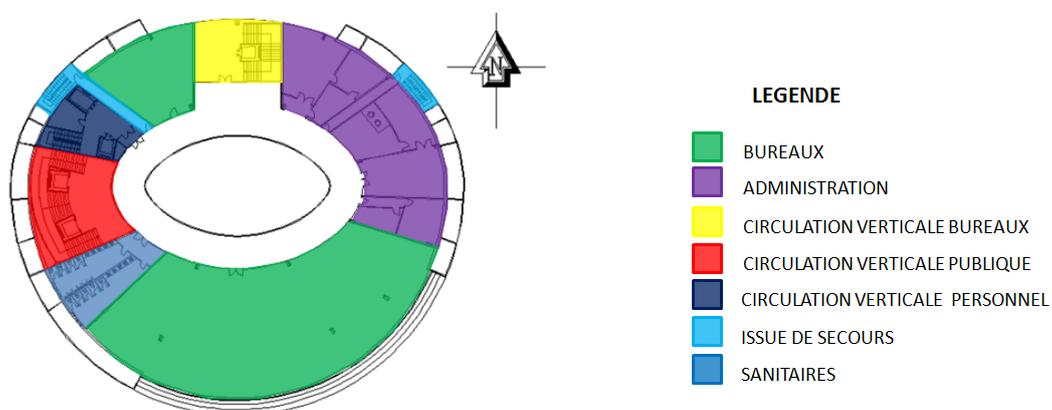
Plan traité du 6ème étage au niveau +26.52.
